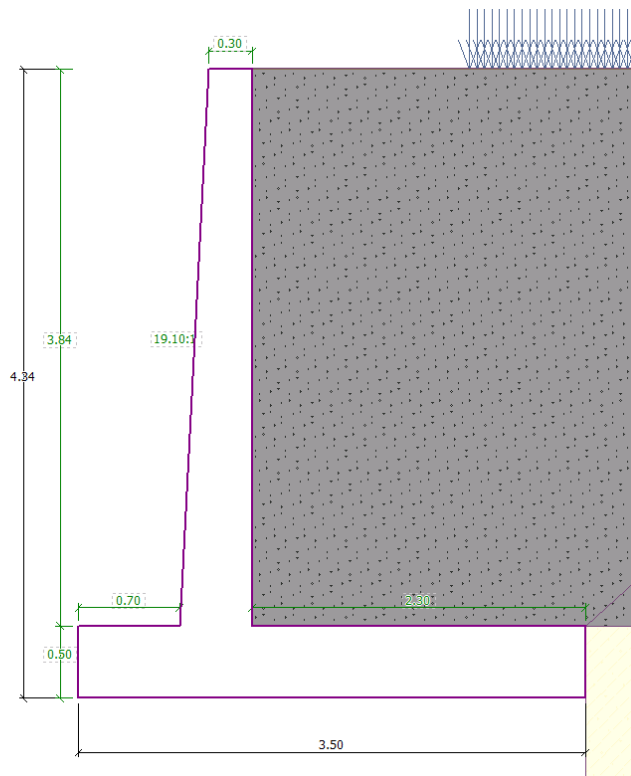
sezione A66 – muro di sostegno: sketch di carpenteria
